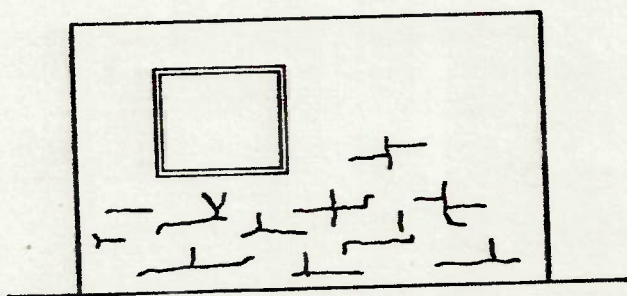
Fissuras na argamassa de revestimento provenientes do ataque por sulfatos
